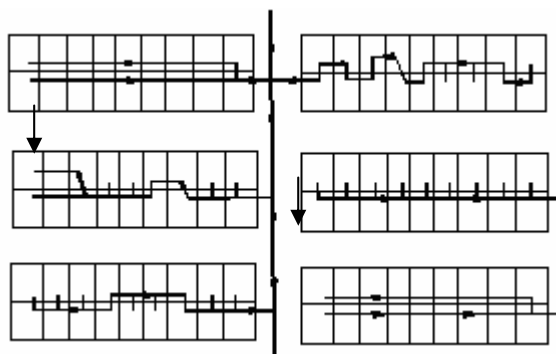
ESQUEMAS DE ALCANTARILLADO CONDOMINIAL
